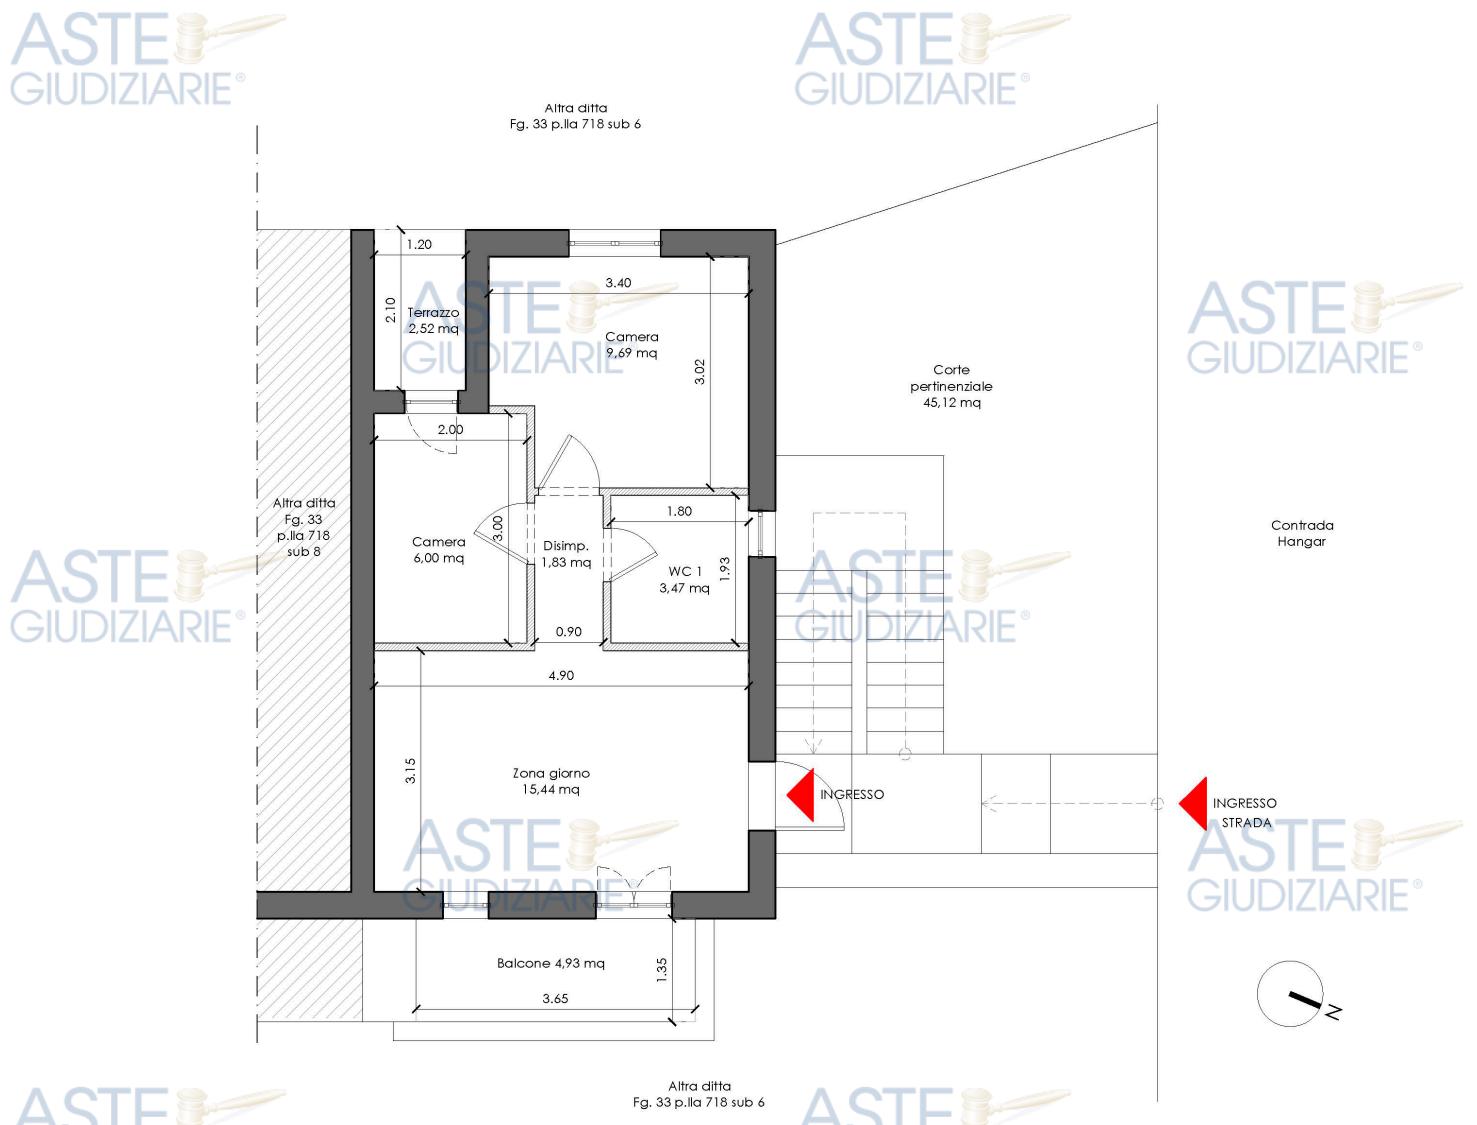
Rilievo Stato di fatto _ Pianta piano primo (Allegato 6D)
